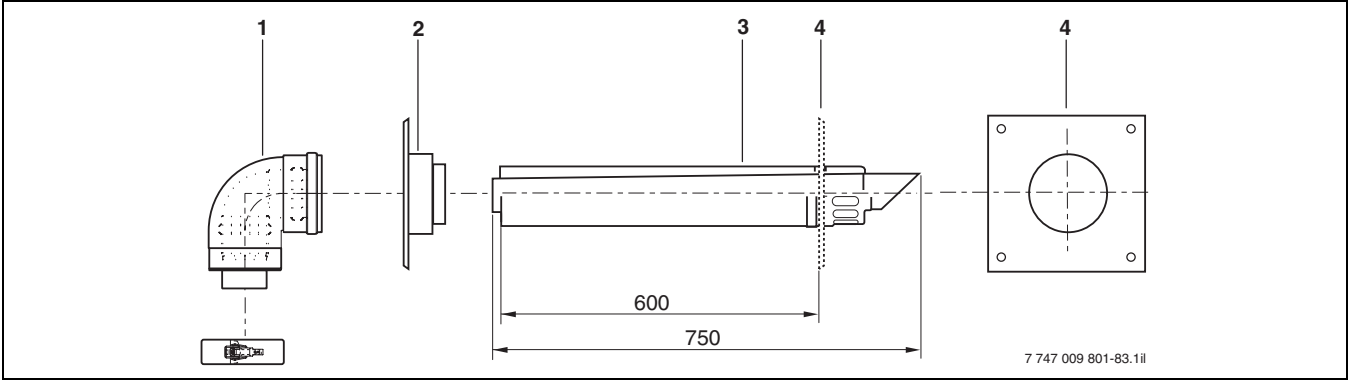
Bauteile des Grundbausatzes WH/WS für U152 (Maße in mm)
